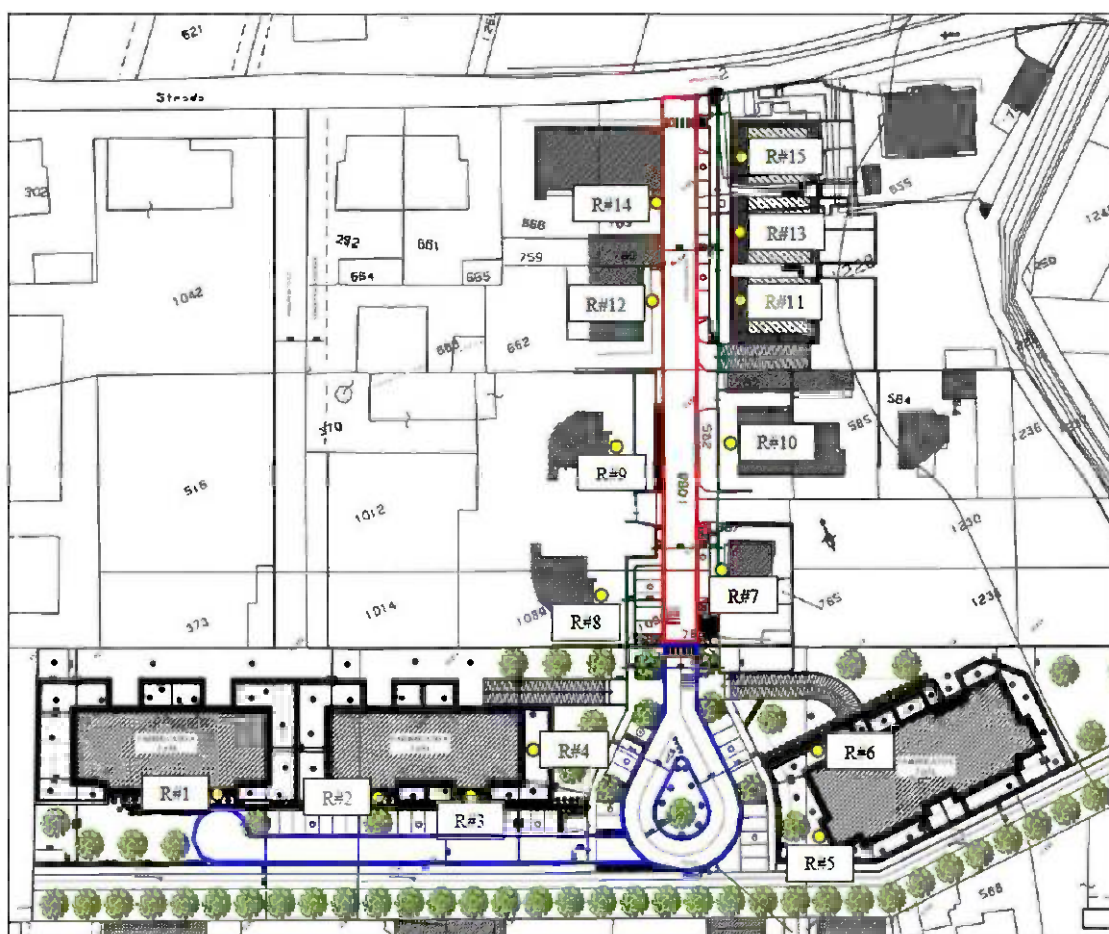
Planimetria generale di progetto con indicazione dei ricettori per il traffico indotto
